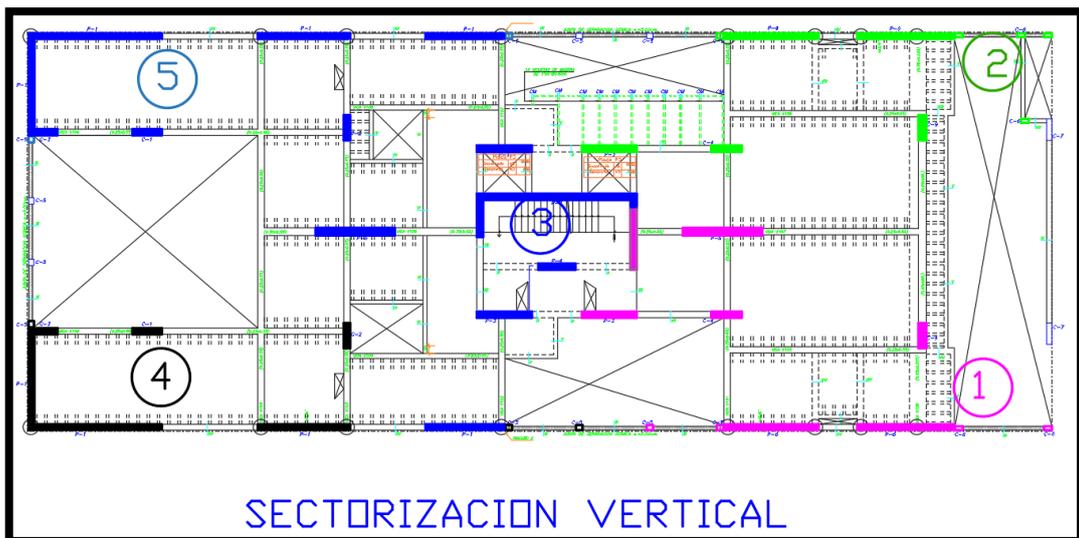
Sectorización de Elementos Verticales para encofrado y Concreto – Piso 2 al Piso 10.
